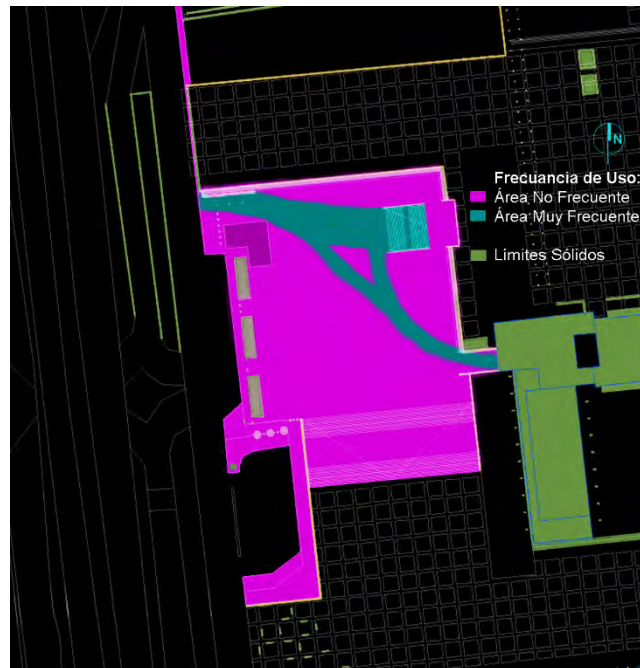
"Plano en planta de Materiales en Pavimento, Niveles de Piso y Flujo de tránsito". Elaborada por, Nami Ota, en noviembre de 2016.
